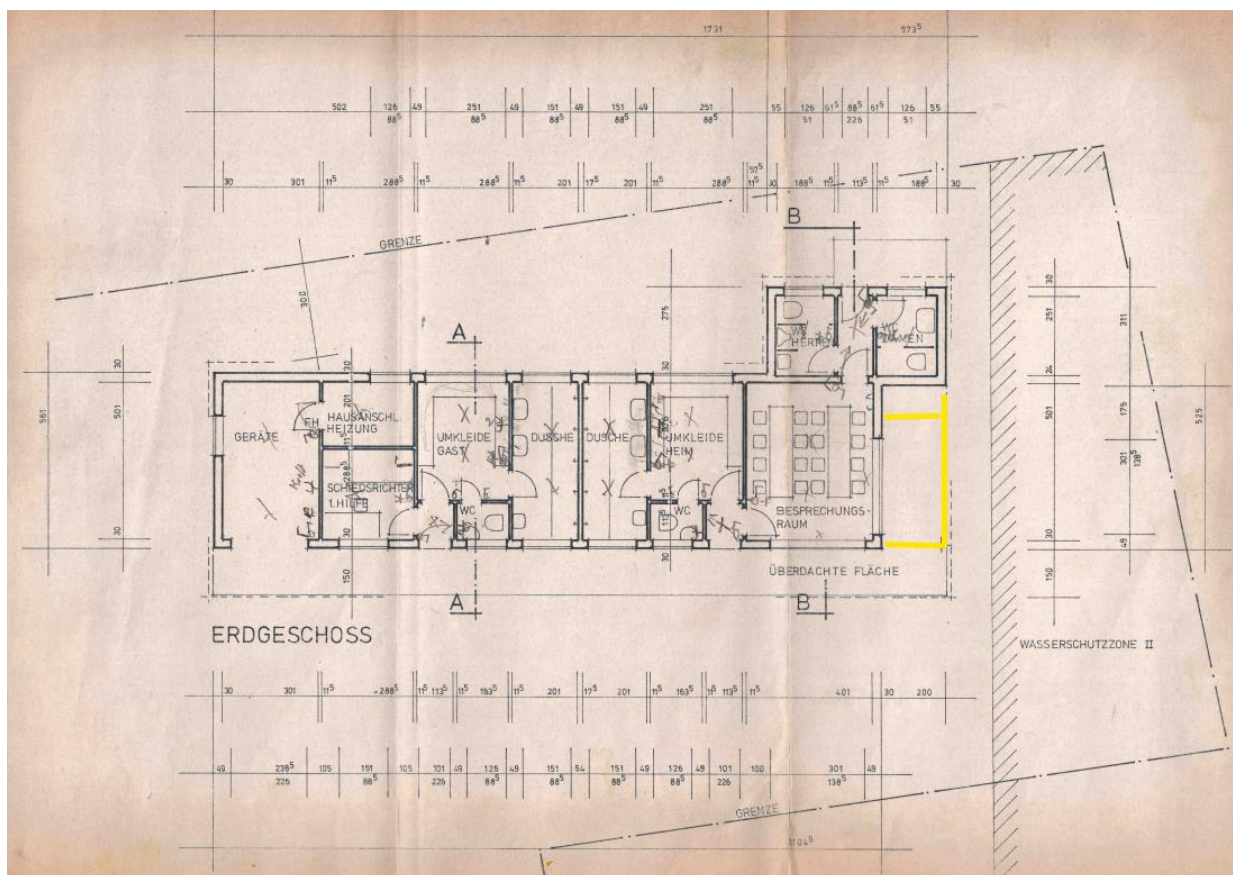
Grundriss des Umkleidegebäudes - Erdgeschoss
